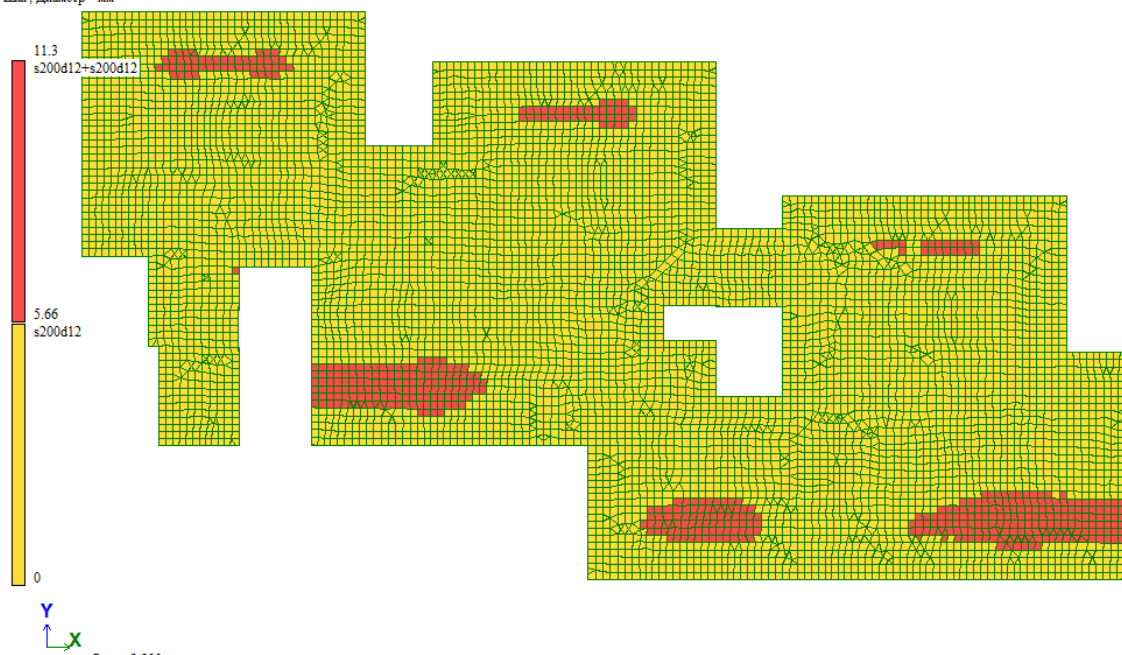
Площадь полной арматуры на 1мм по Y у нижней грани
